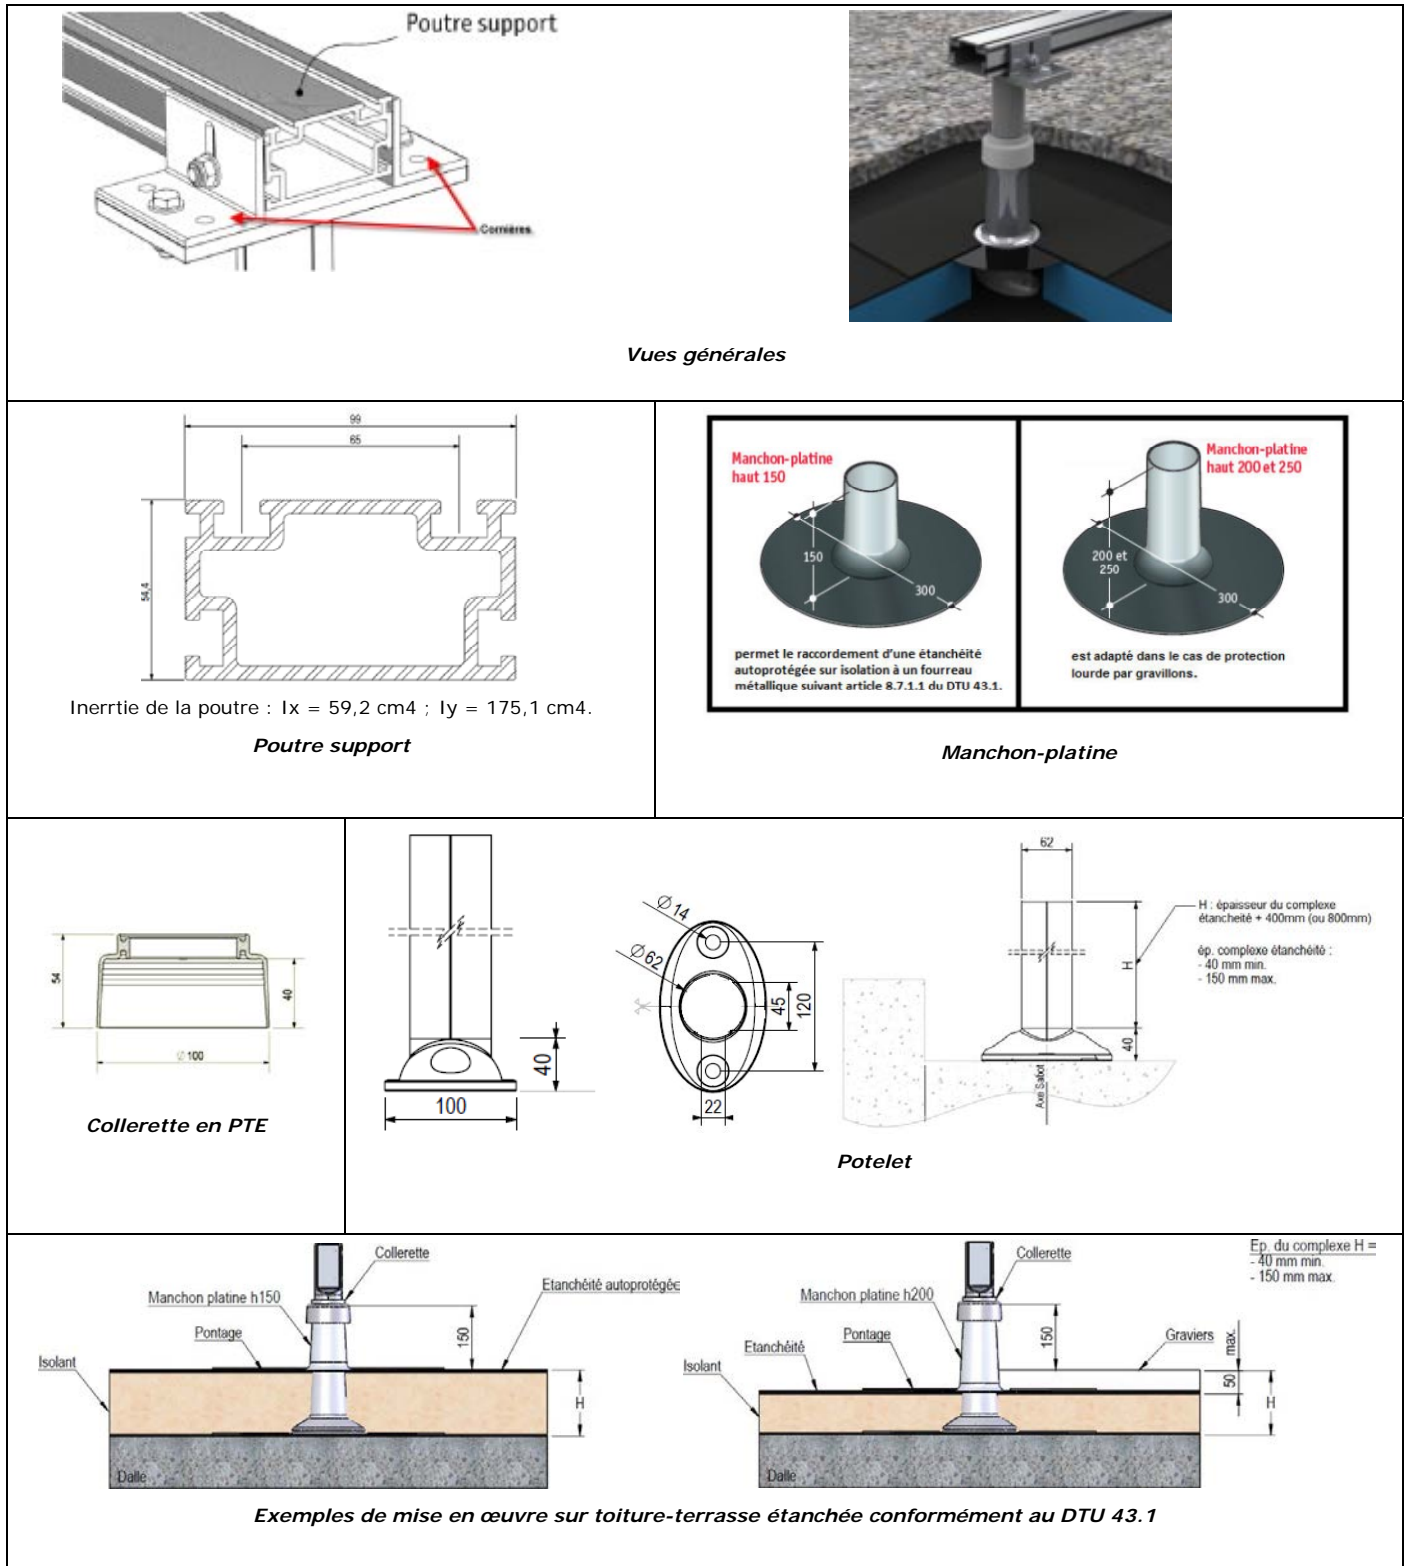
Solution de fixation sur toiture plane avec des systèmes SOLFIX
